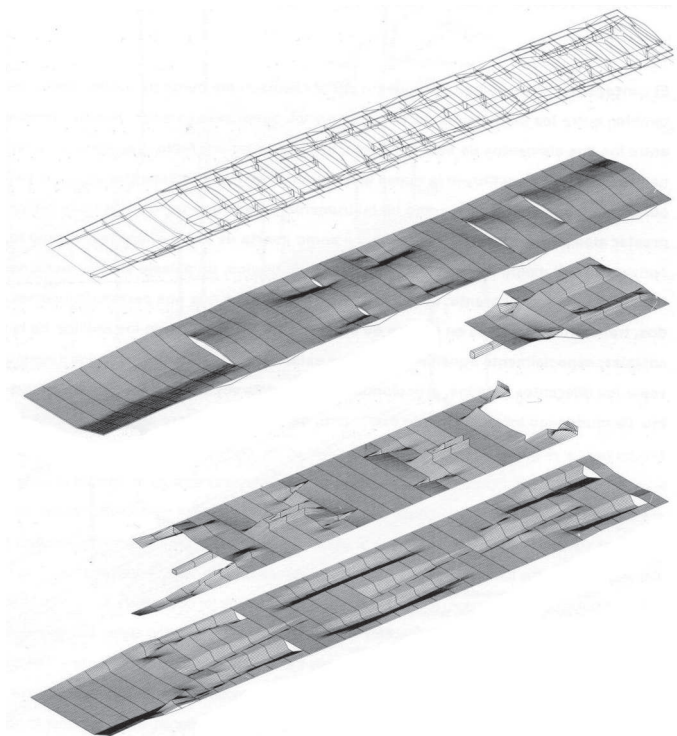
Proyecto del edificio Olivetti, Rosario (planta tipo y vista)
